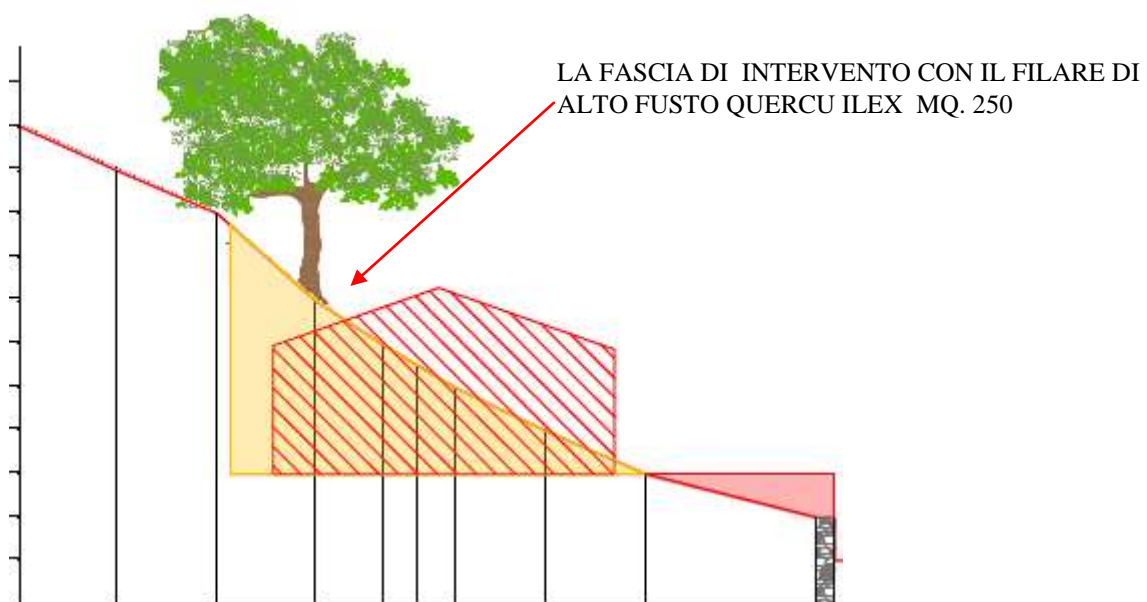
elaborato da tavola di raffronto – sezione Arch. Galletto
